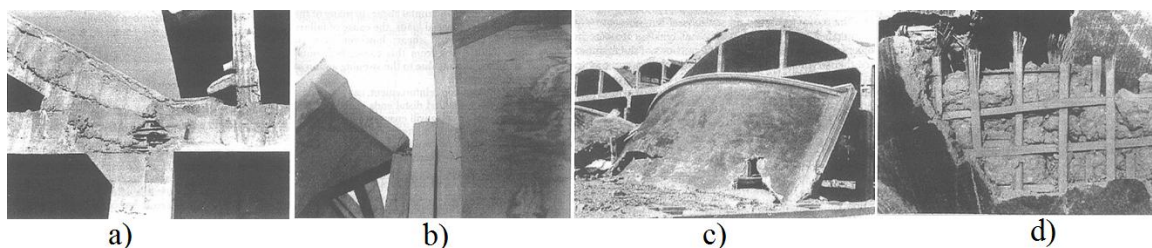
(Hidalgo-López 2003) a) - zona exposta a sombra e não ventilada; b) - corte da armadura no colapso do pilar (insuficiência da armadura), c) - colapso da laje por expansão das juntas no apoio; d) - destacamento por falta de aderência bambu-betão.
